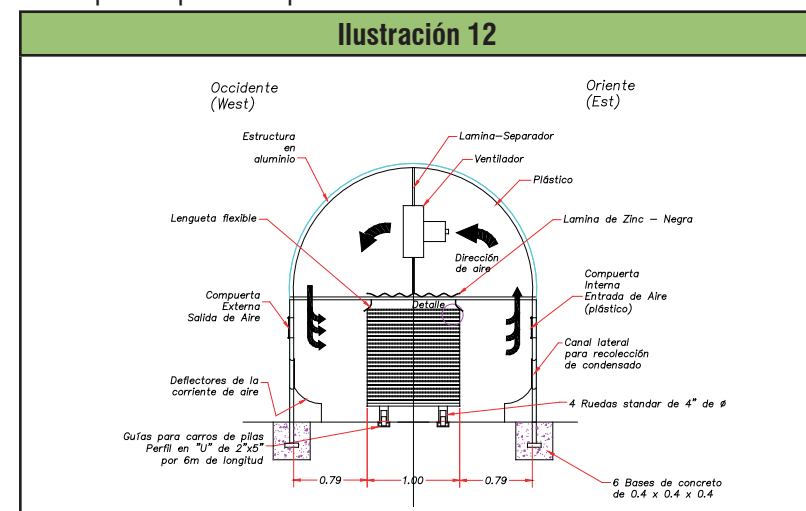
Conjunto secador solar tipo invernadero ventilación transversal, vista frontal.
